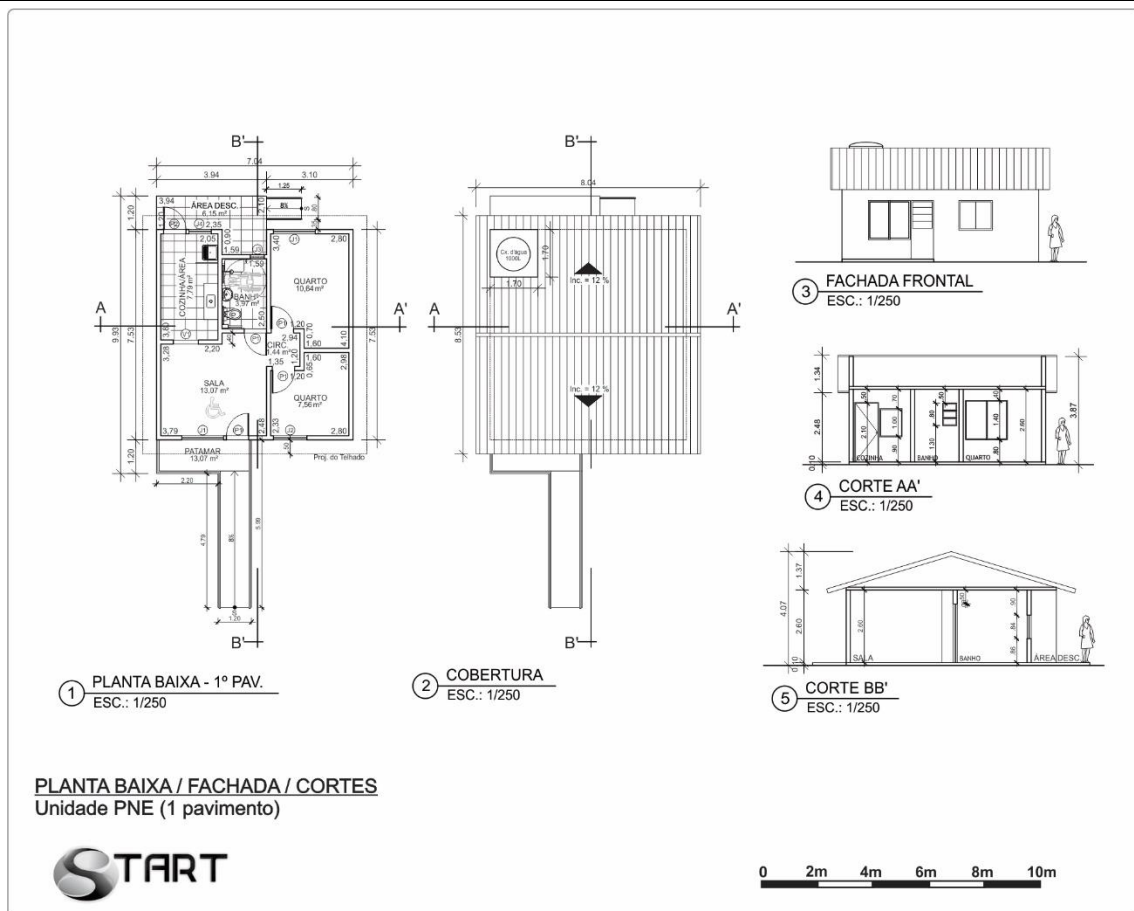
Planta baixa, fachada e cortes da unidade PNE de 1 pavimento
